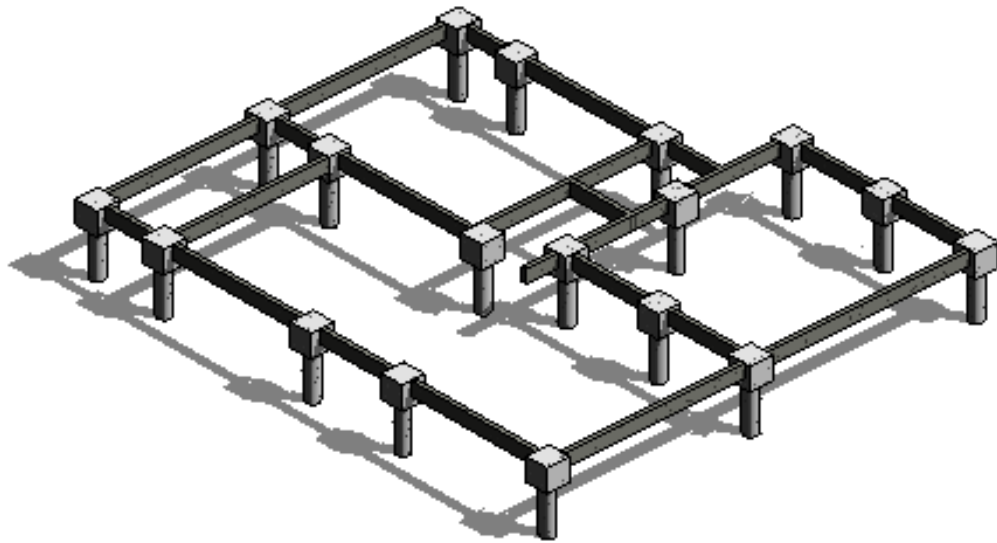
Modelagem das vigas baldrame, blocos e estacas da planta de fundação
